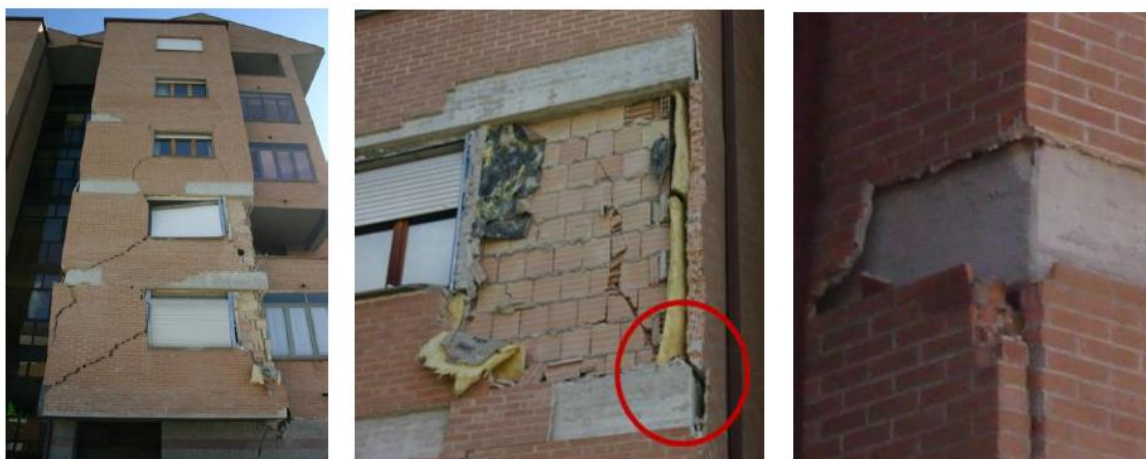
Fissuração e colapso parcial do pano exterior da parede dupla [3].
